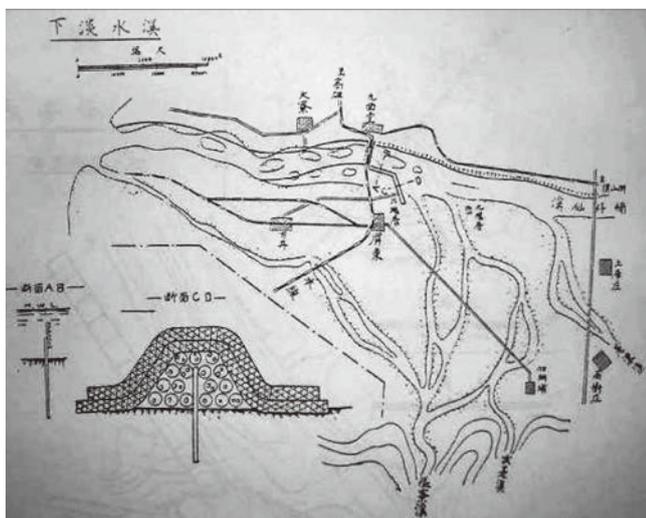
下淡水溪災害復舊工事平面圖及鐵筋混凝土樁、蛇籠堤設計略圖（《顧台》1936 年）
